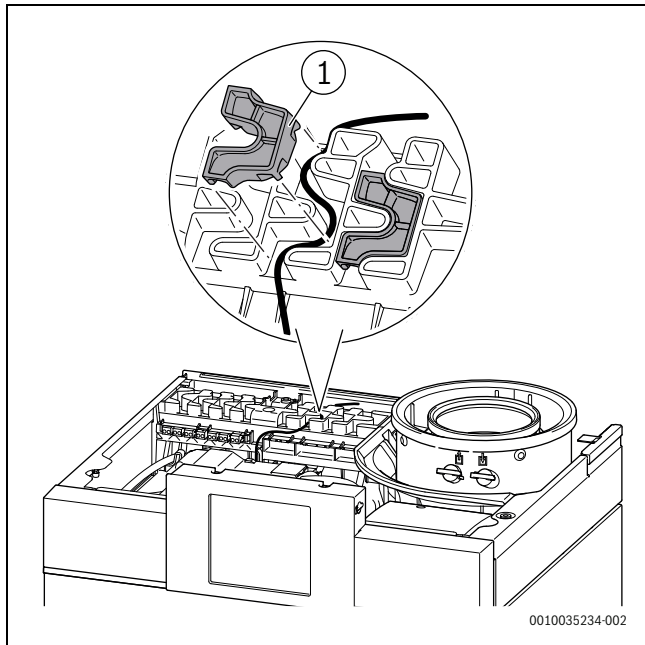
Posizionamento del cavo di collegamento e del passacavo
